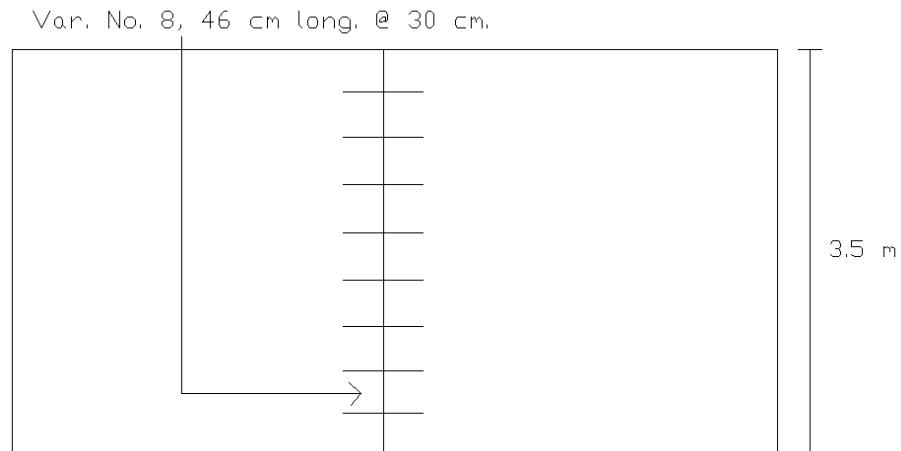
Juntas transversales para diseño de pavimento rígido.
